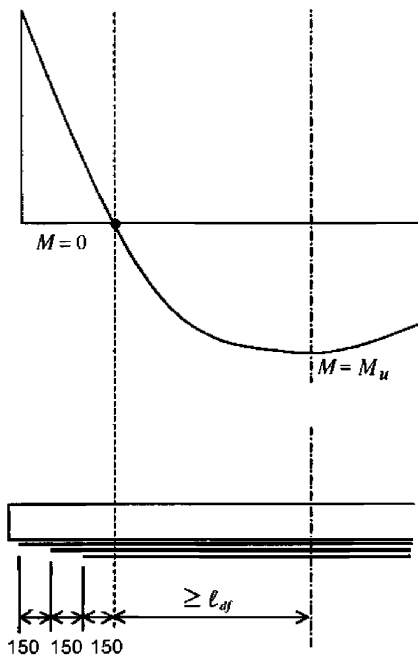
Схема анкеровки многопролетных железобетонных конструкций
